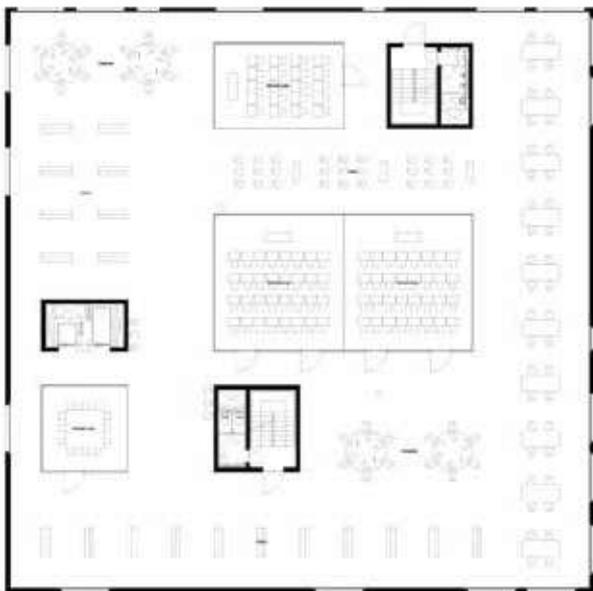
Zeche Zollverein, SANAA, Grundriss
